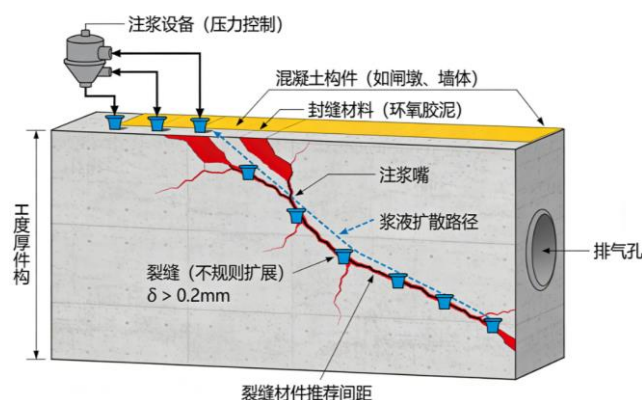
压力注浆法修补混凝土裂缝施工示意图
